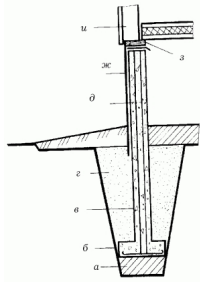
Устройство столбчатых фундаментов из асбестоцементных труб: а – уплотненный грунт; б – железобетонный анкер; в – асбестоцементная труба; г – обратная засыпка; д – арматура; ж – заборка из асбестоцементного листа; з – доска-подкладка; и – деревянная стена.
